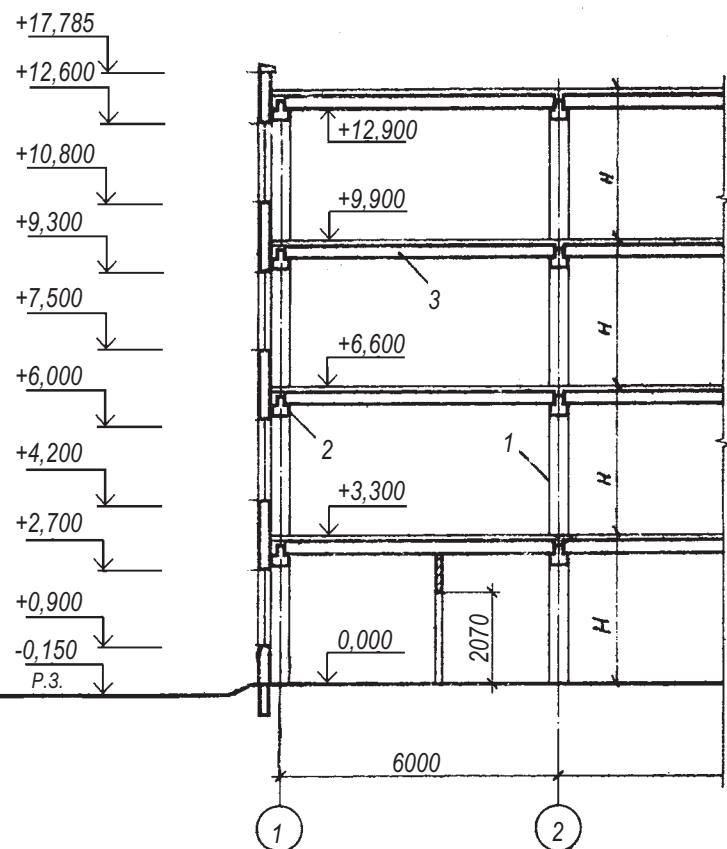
Розріз будівлі з укладкою збірних панелей на ригелі:
